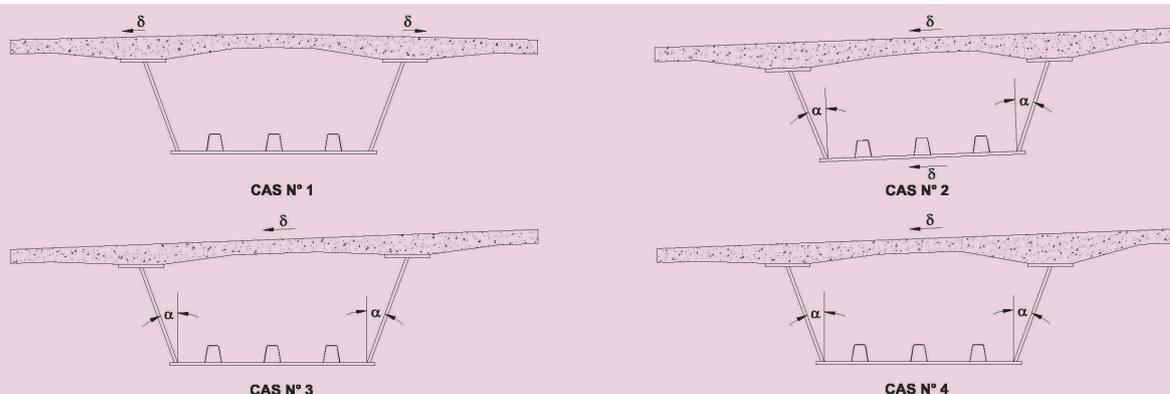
Morphologie des caissons selon le dévers de la chaussée portée
